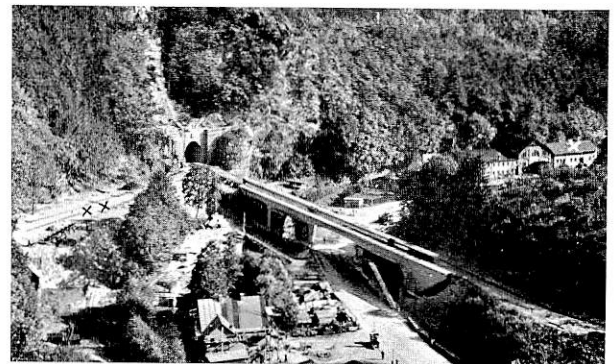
Westlicher Tunneleingang sowie Plätze X und X' für Baustelleneinrichtung.
